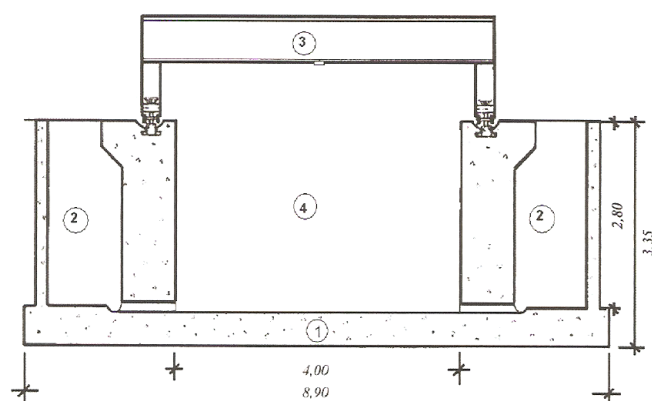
Planta da fossa de ensaios do LNEC (sem escala)
